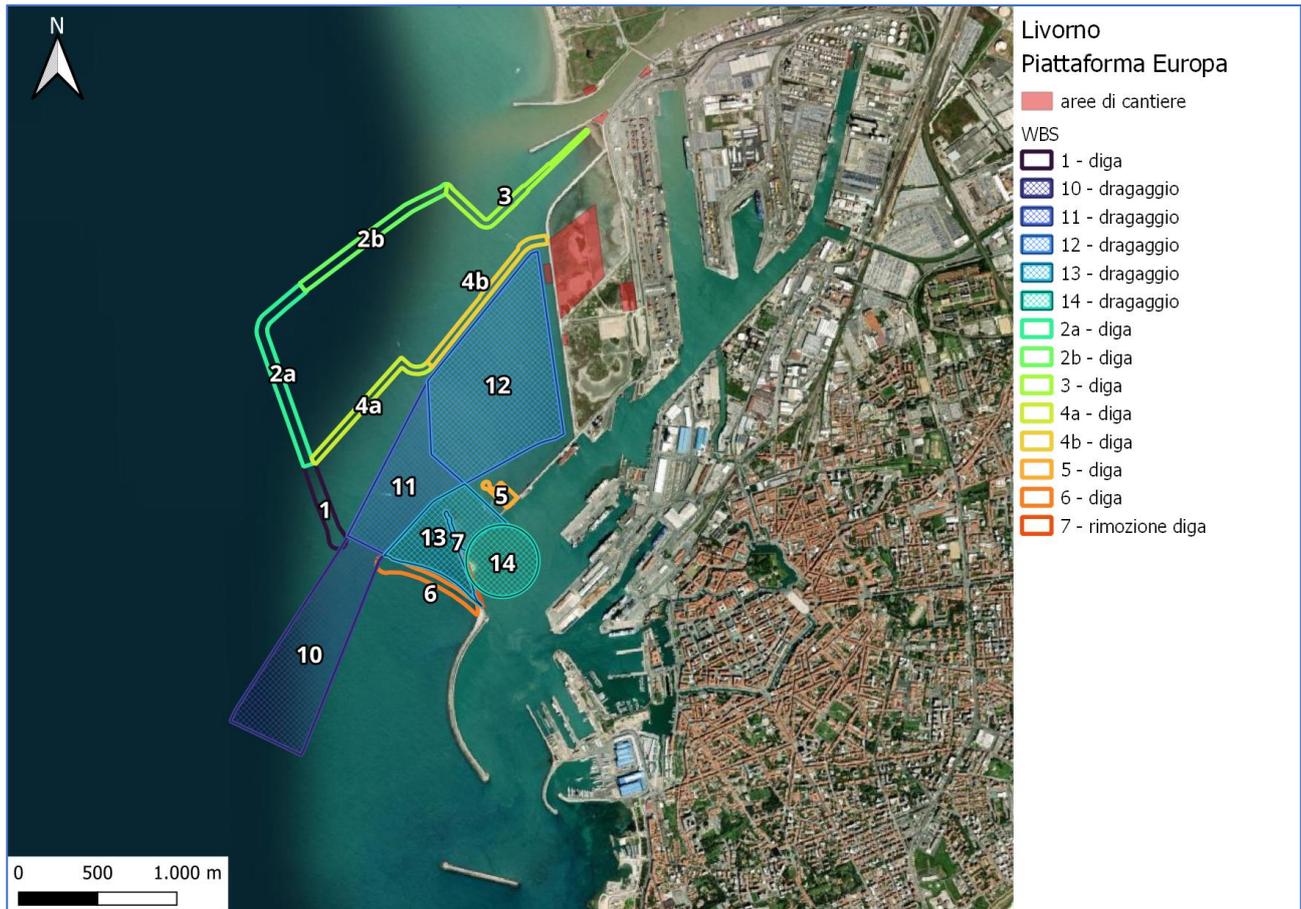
Individuazione delle WBS e delle aree di cantiere previste
